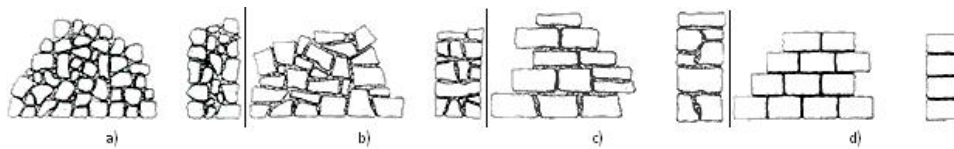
a) alvenaria não aparelhada; b) aparelhada numa face; c) aparelhamento parcial disposto em camadas; d) perpianho
